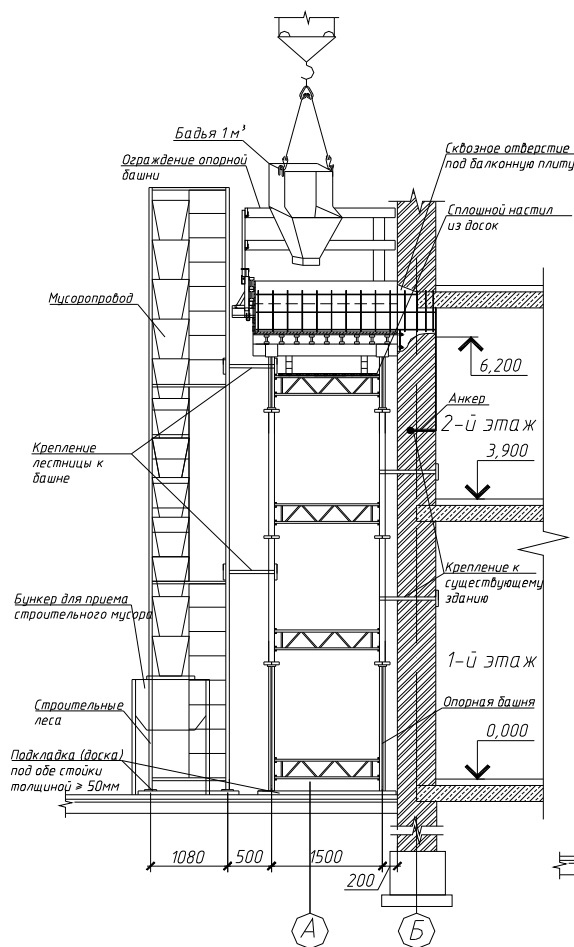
Схема бетонирования балконной плиты после устройства штробы и сквозного отверстия с настила на промежуточных опорах опорной башни на уровне 3-го этажа
